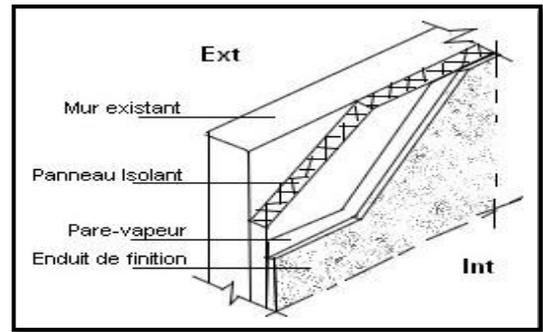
Panneau d'isolation recouvert par un enduit (Source : www.isover.fr)
